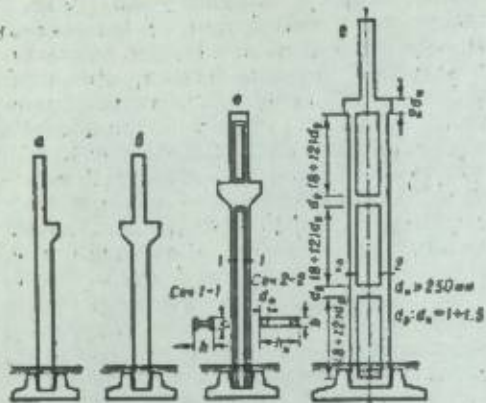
Железобетонные стойки промышленных зданий: а и б — прямоугольного сечения; в — двутаврового сечения; г — двухветвиная.
